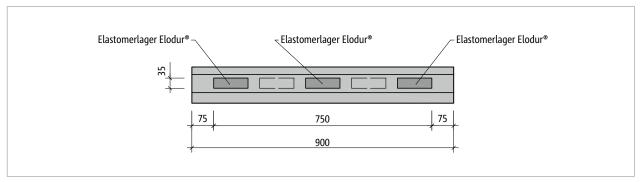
Schöck Tronsole® BL, BZ: Grundriss, beispielhafte Darstellung Tragstufe V1, Länge 900 mm
